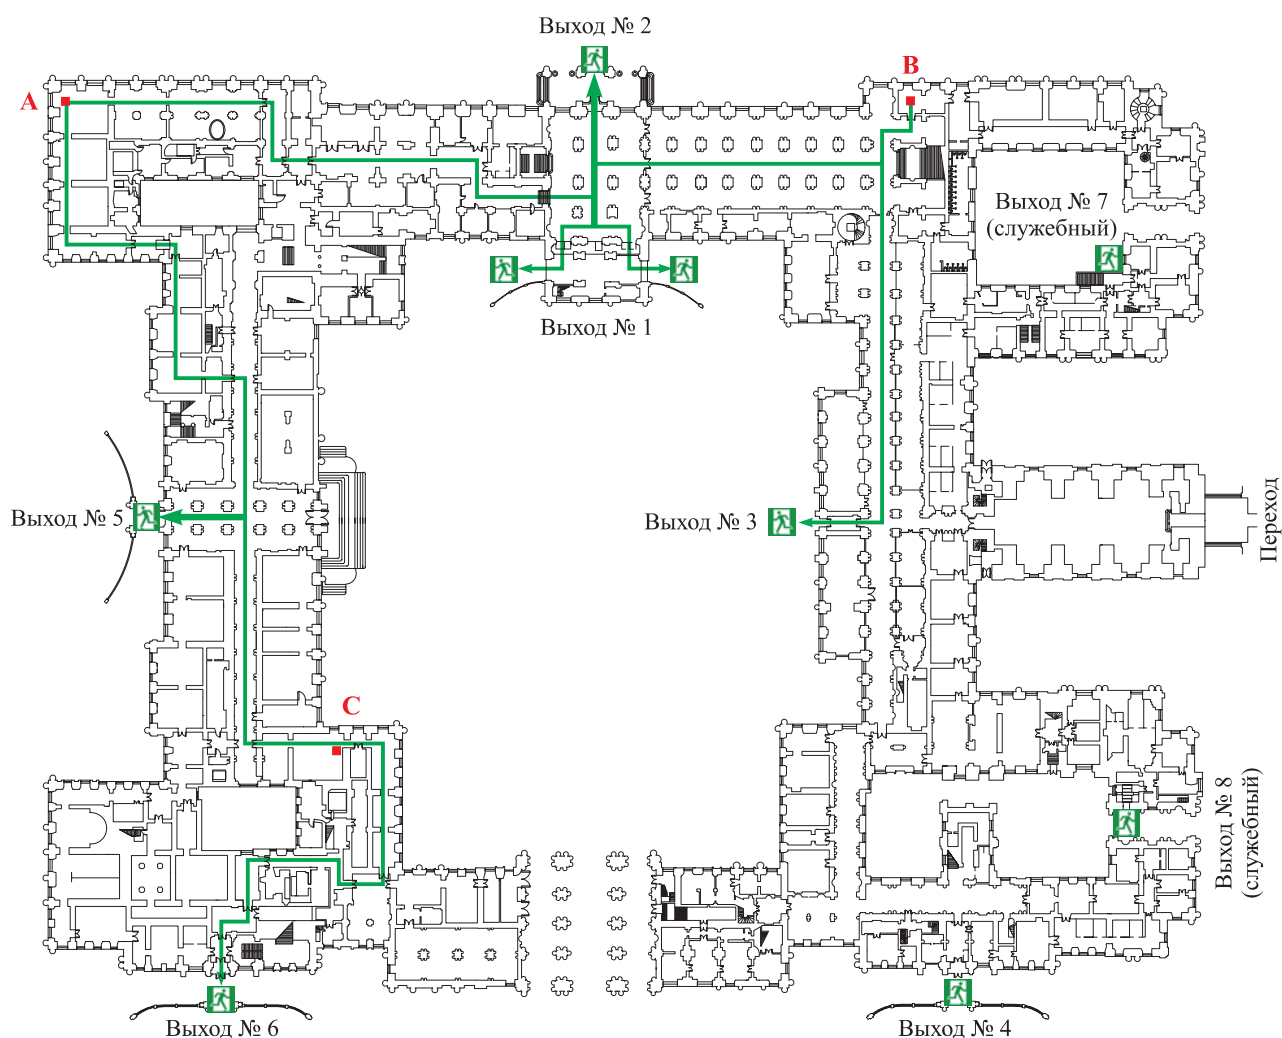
План 1-го этажа Зимнего дворца Государственного Эрмитажа
